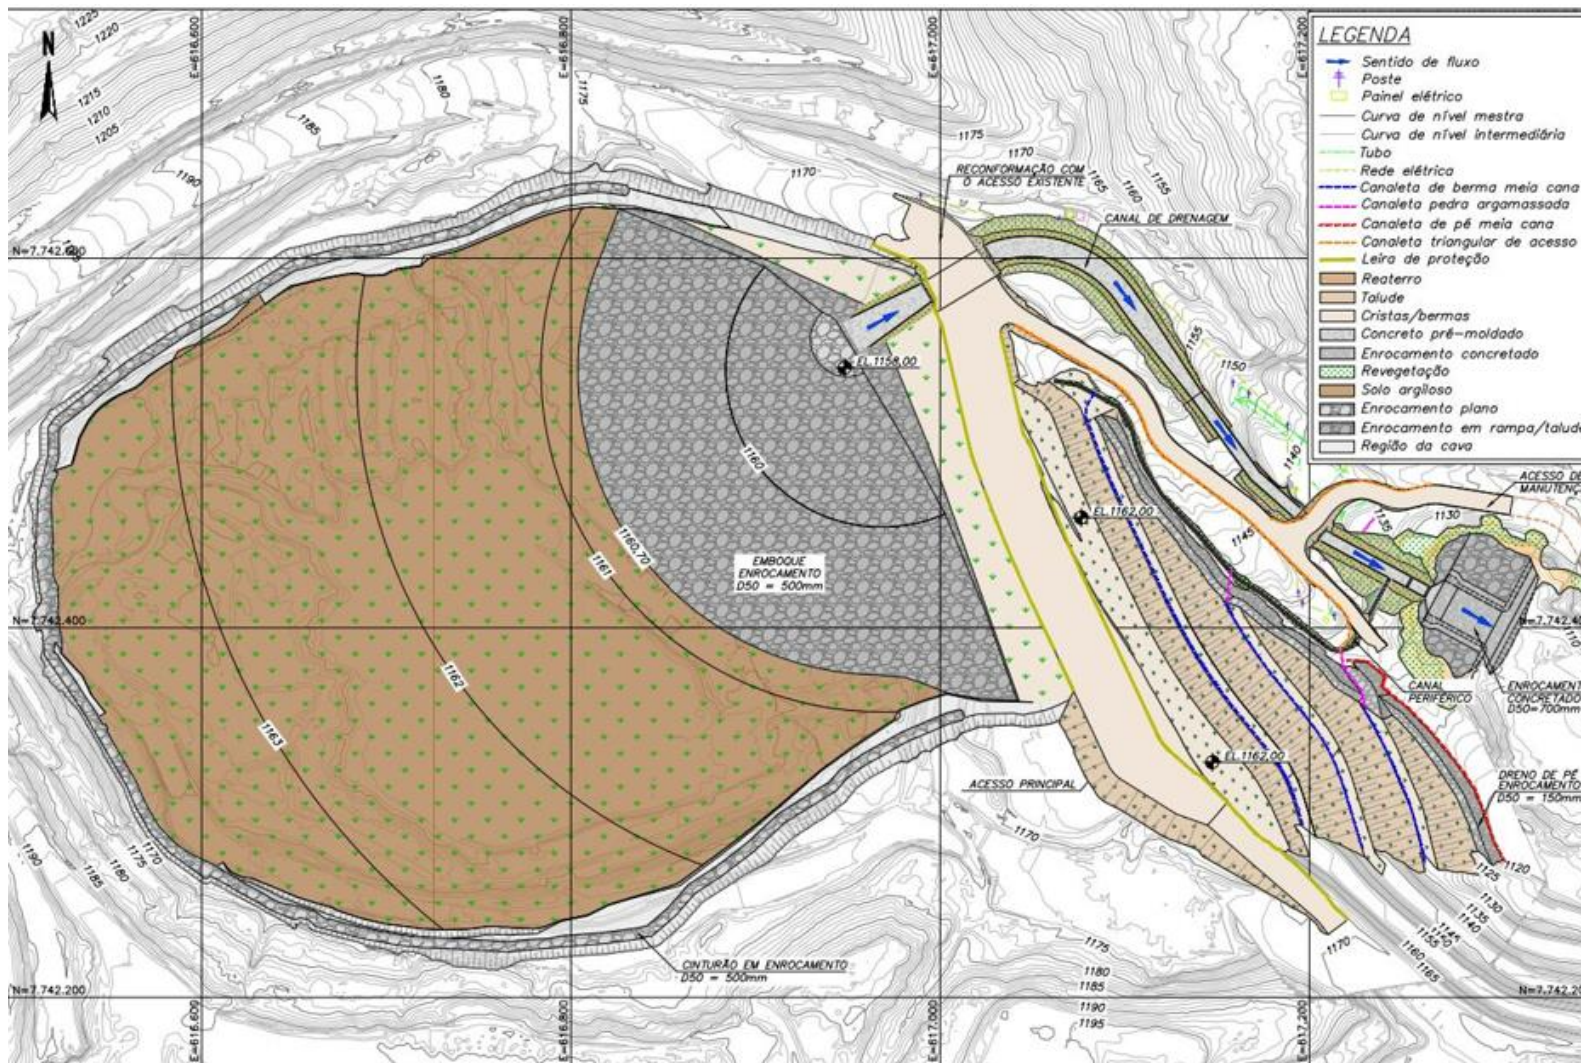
Arranjo Geral do Projeto de Descaracterização da Barragem da Área IX.
